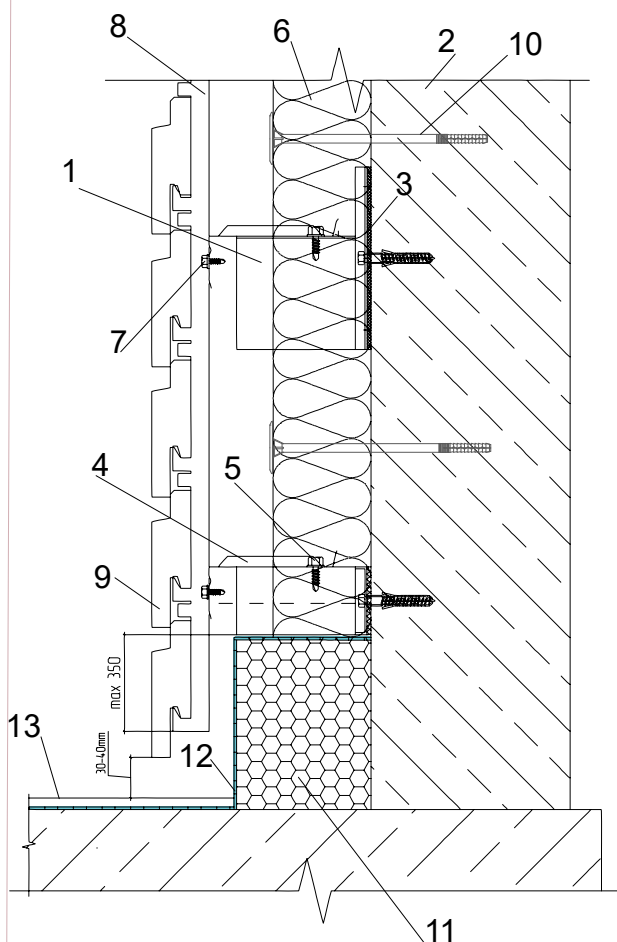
а. Примыкание фасада к тротуару или балкону. Вертикальный разрез.
